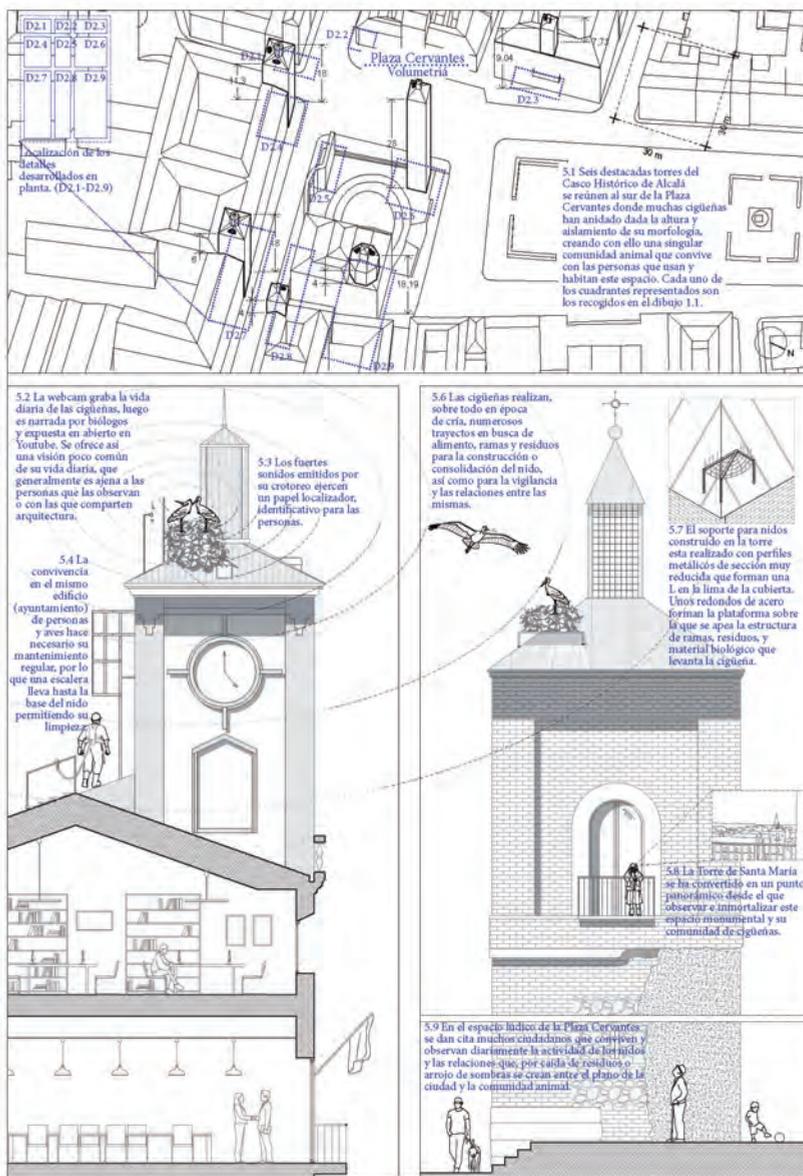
Lámina 5. Volumetría de la Plaza Cervantes y alzados de la torre del ayuntamiento y la torre de Santa María. Elaboración de los autores, 2023.
